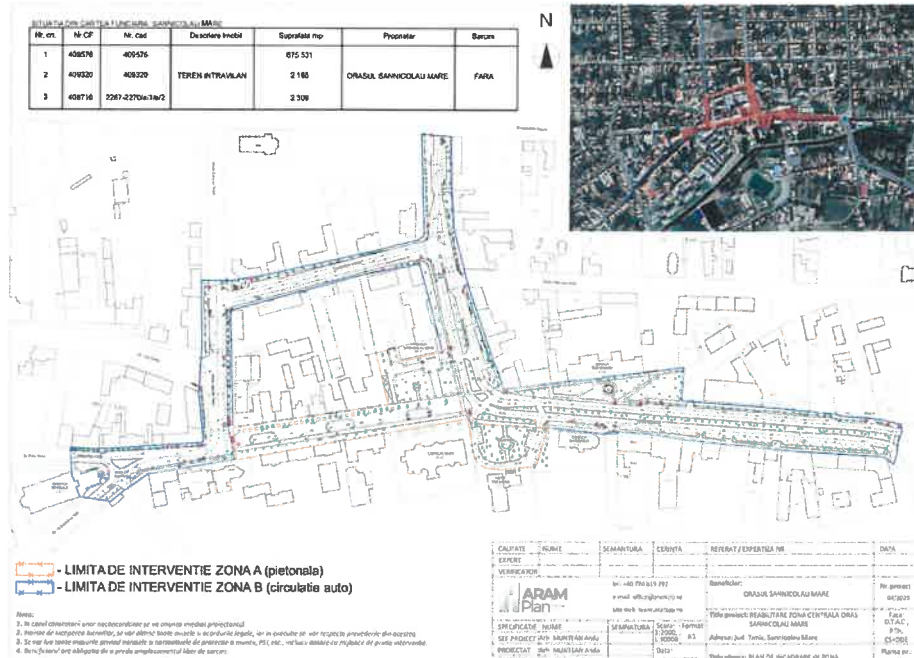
Extras din plan de încadrare în zonă cu delimitarea zonelor de intervenție
